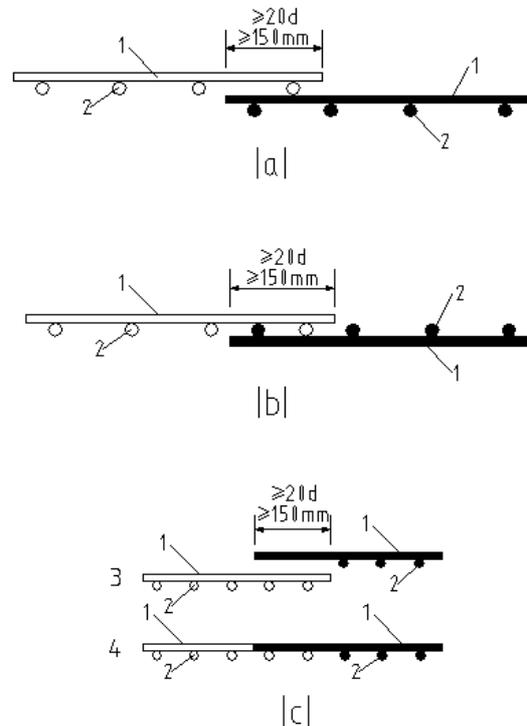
钢筋焊接网在非受力方向的搭接
